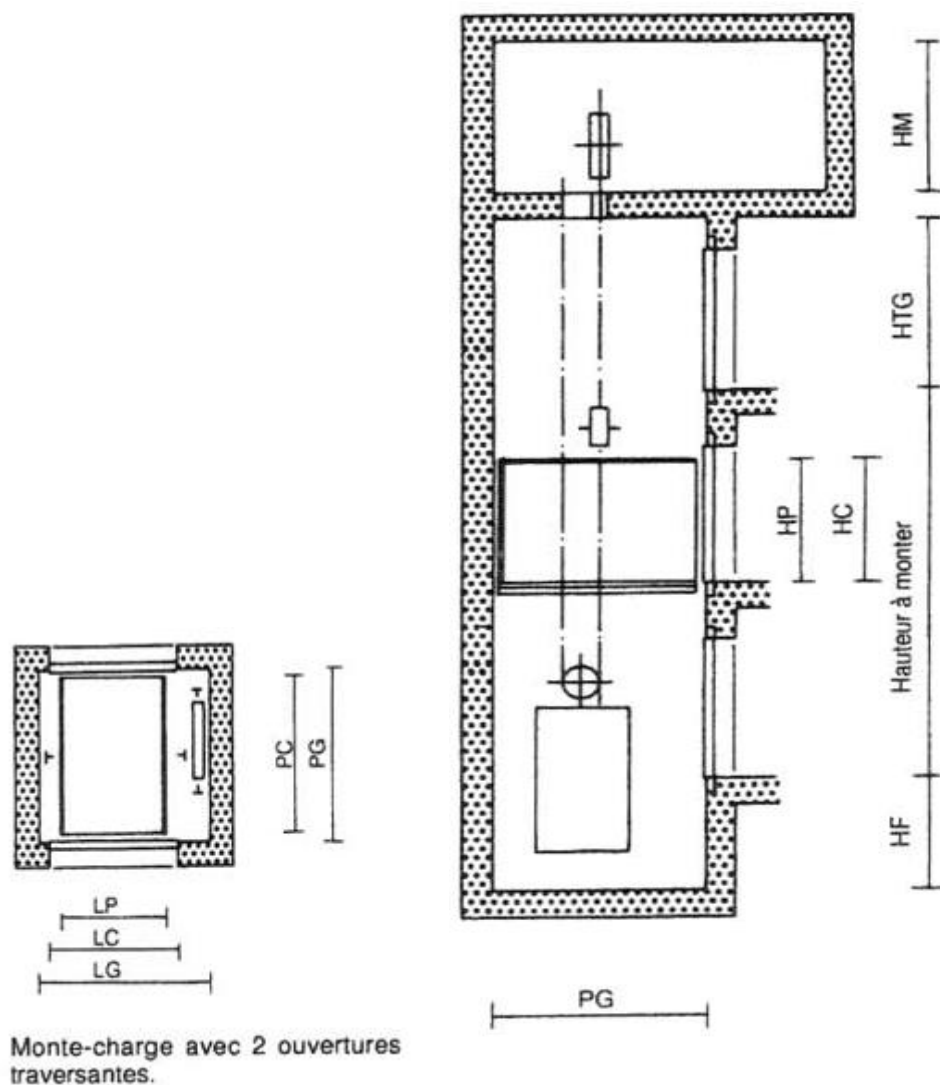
Vue en plan et coupe transversale d'un monte-charge
